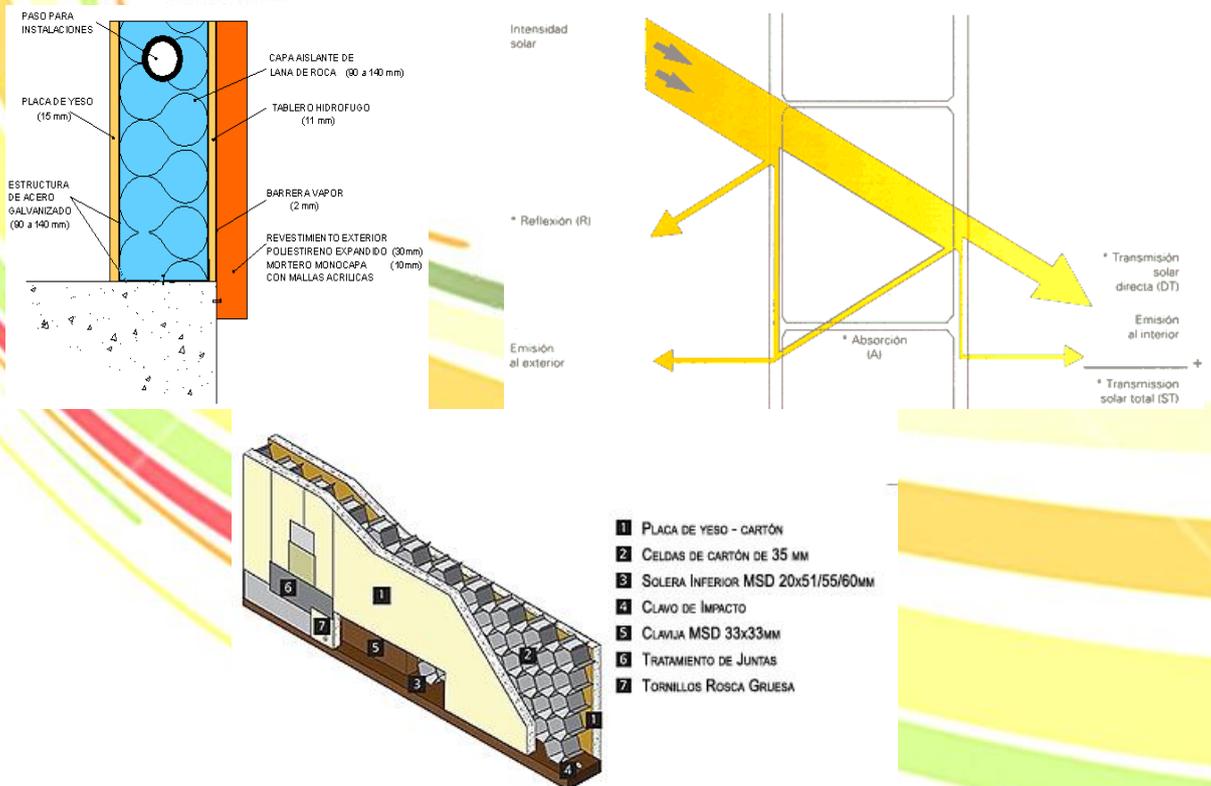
Sistema Driwall Para Muros Y Características.
